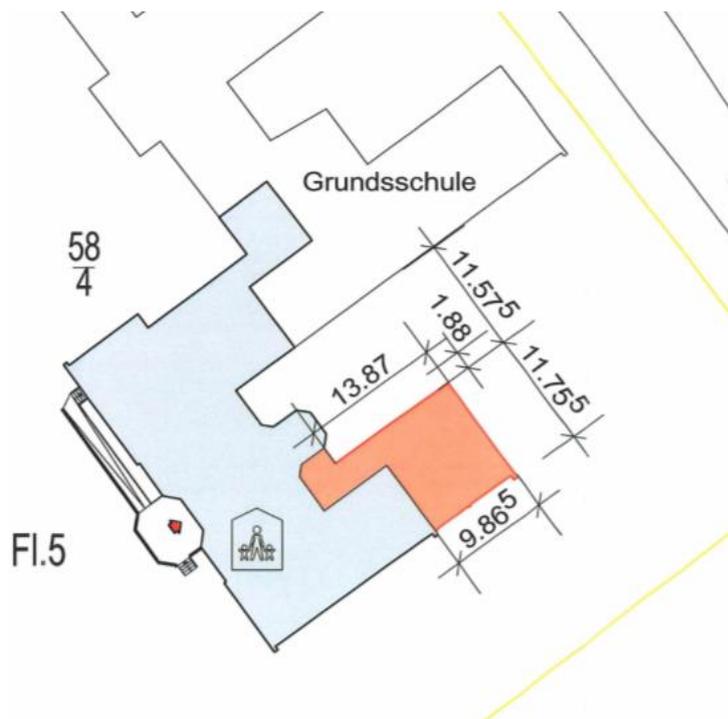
Lageplan des zu bewertenden Gebäudes
